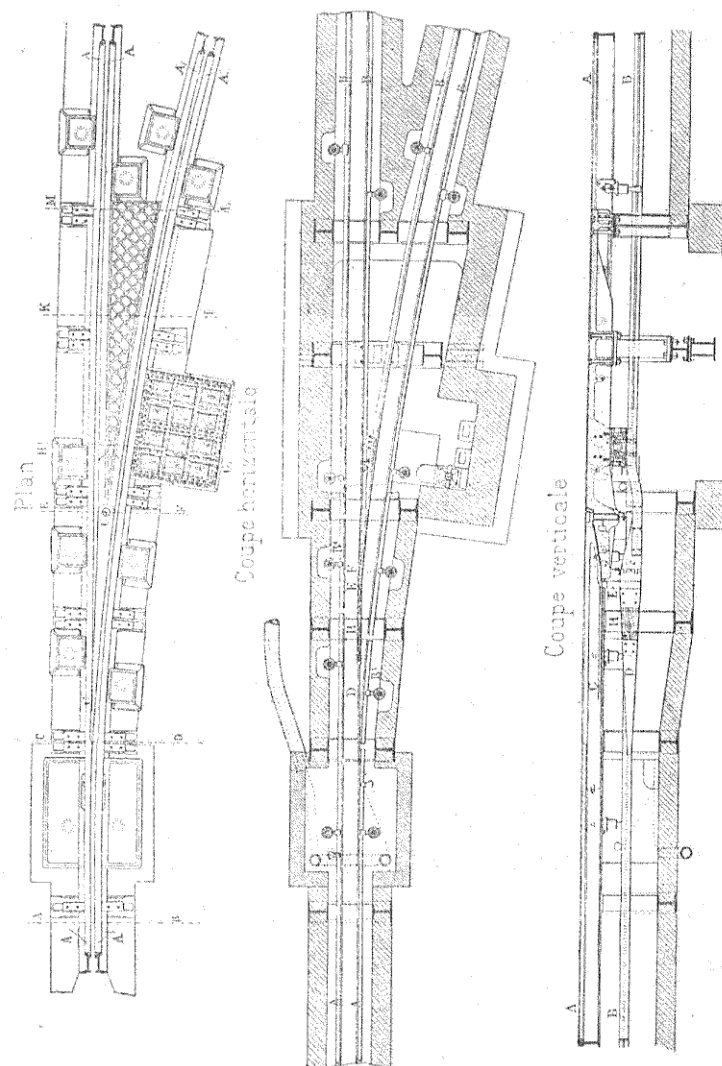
, 641 et 642. — Plan et coupe d'un aiguillage.
